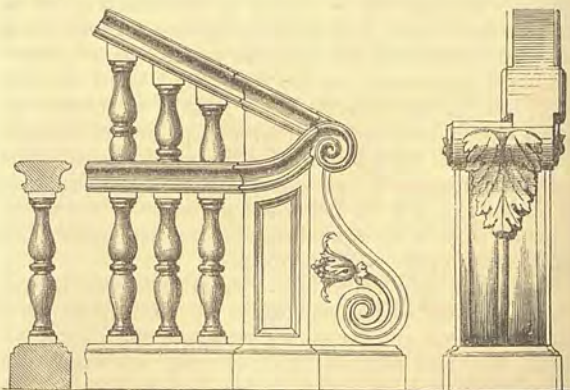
Parapetto scala sotto la Galleria Nazionale a Torino (architetto Riccio).
